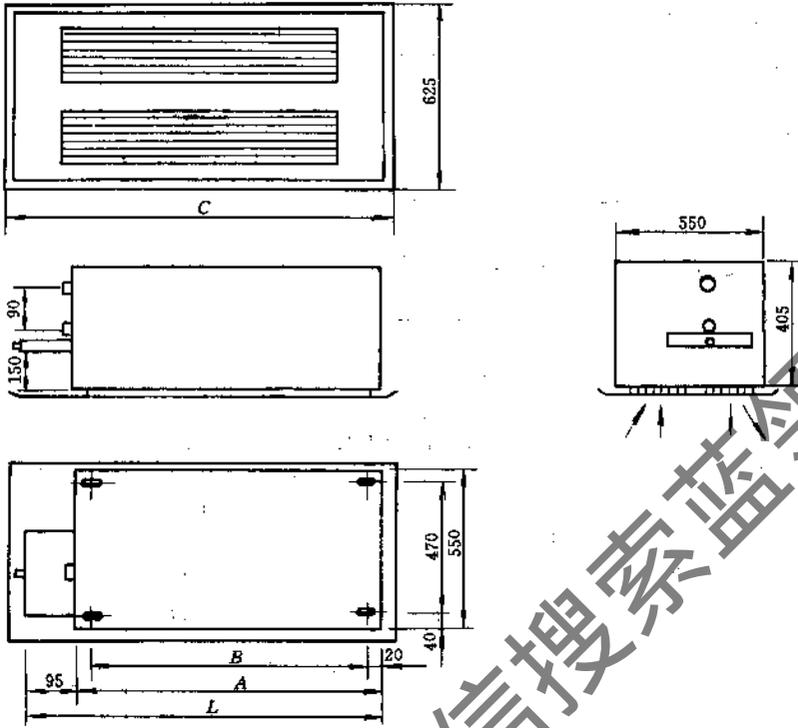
FP-WM 系列 (卧式、明装) 风机盘管外形尺寸图
